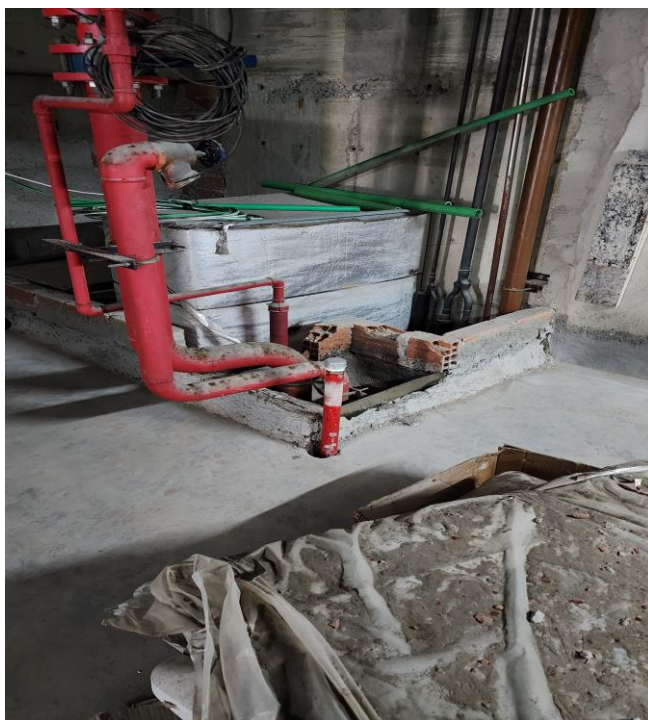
Demonstração da Patologia da Tubulação de aço galvanizado de 32 mm – 2º Subsolo
